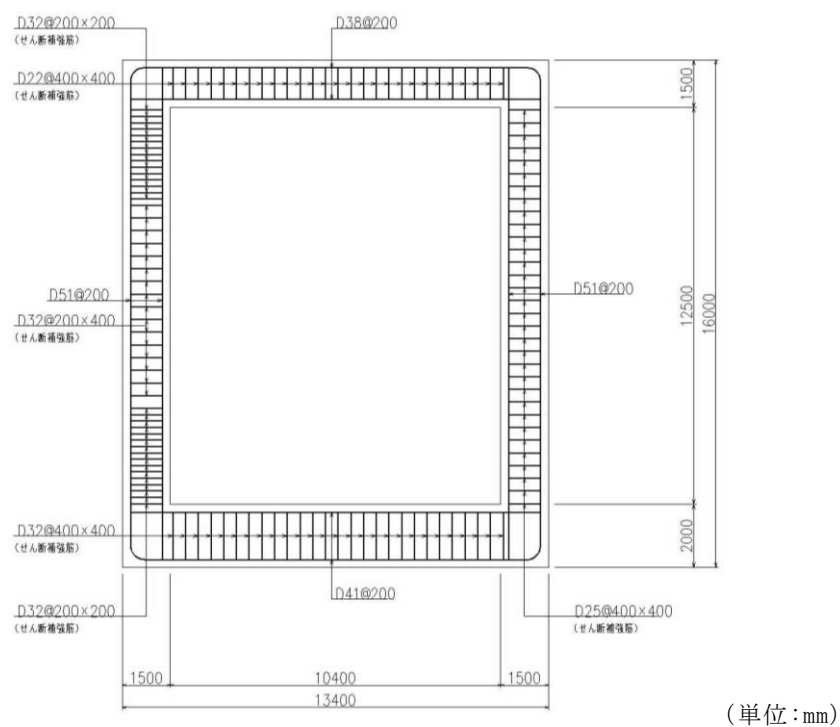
低圧原子炉代替注水ポンプ格納槽 概略配筋図 (B-B 断面)
